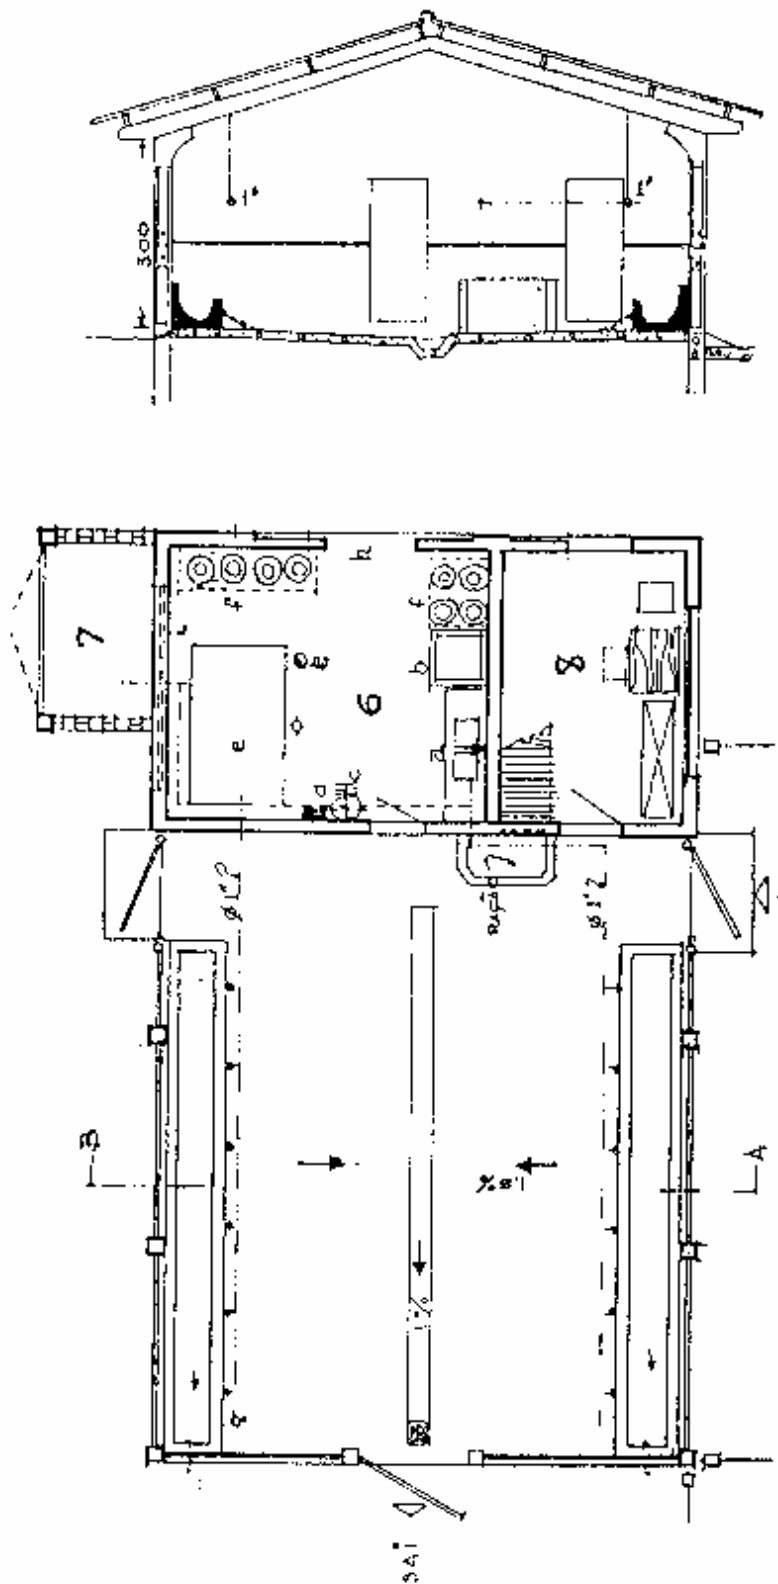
Detalhes da Construção da Sala de Ordenha
